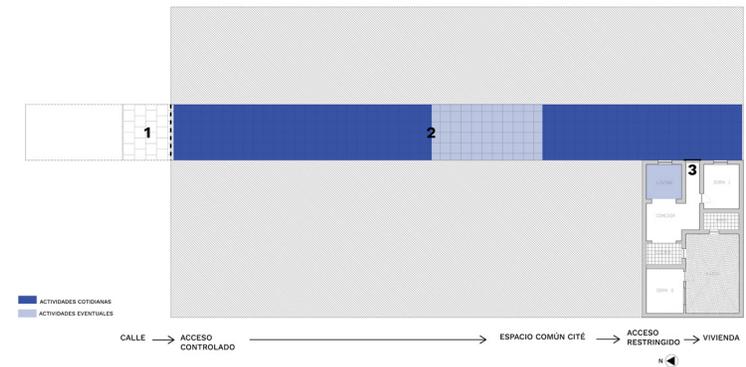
Planta cité y sus niveles de profundidad . Elaboración propia.
